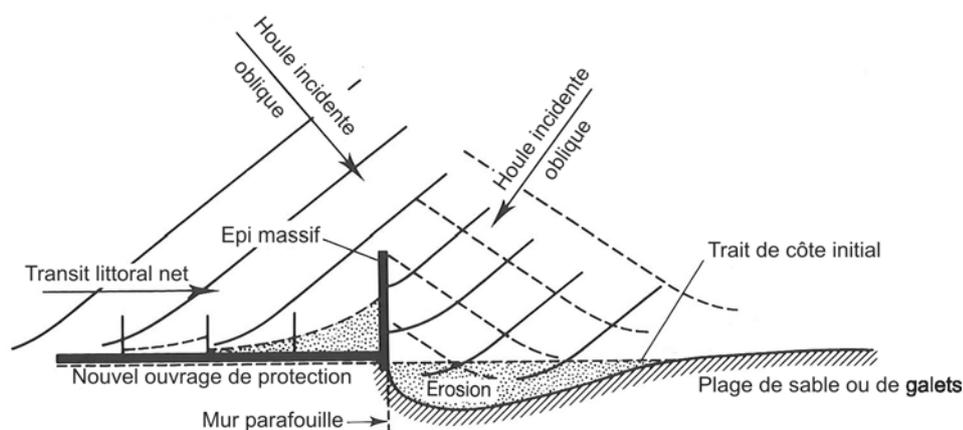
Érosion à l'extrémité d'un mur de haut de plage
